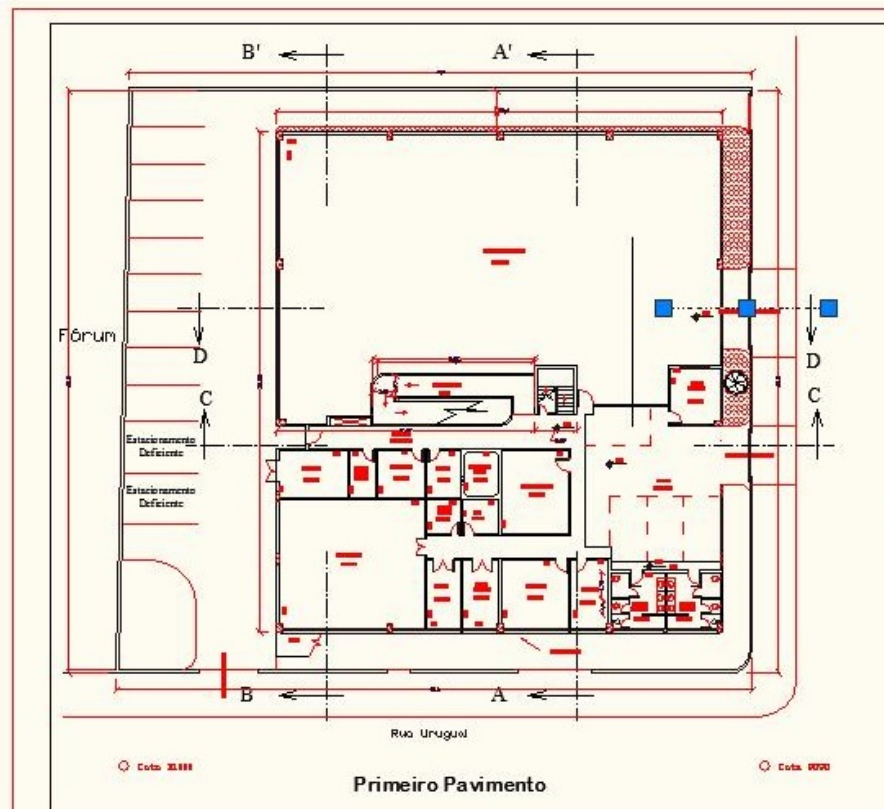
Planta baixa original – Pavimento Térreo - IRF/Jaguarão-RS
